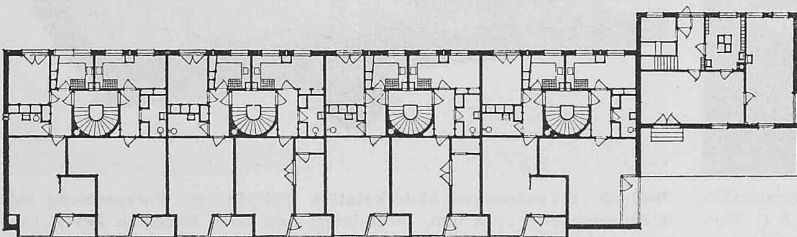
Gentofte. Erdgeschossgrundriss 1:500.
